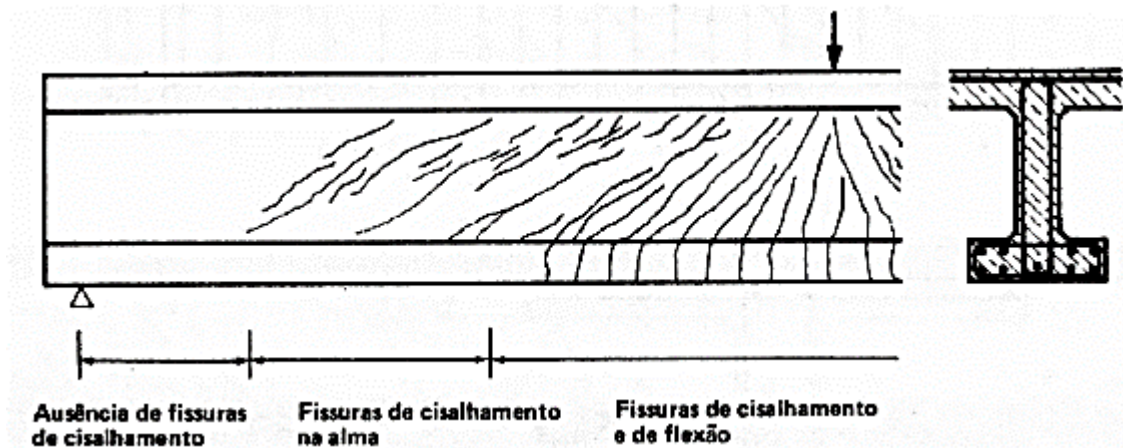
Fissuras de força cortante perto do apoio, na alma de uma viga I, que não se originam de fissuras de flexão (LEONHARDT e MÖNNIG, 1977)
